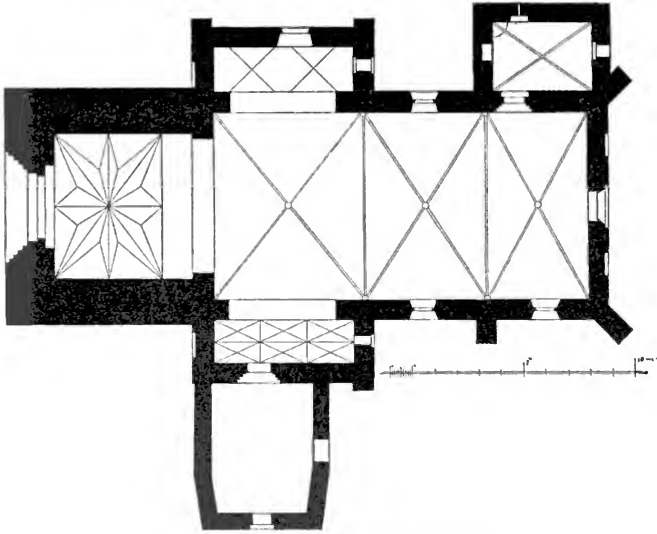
Grundriß der Pfarrkirche in Pettelkau.
